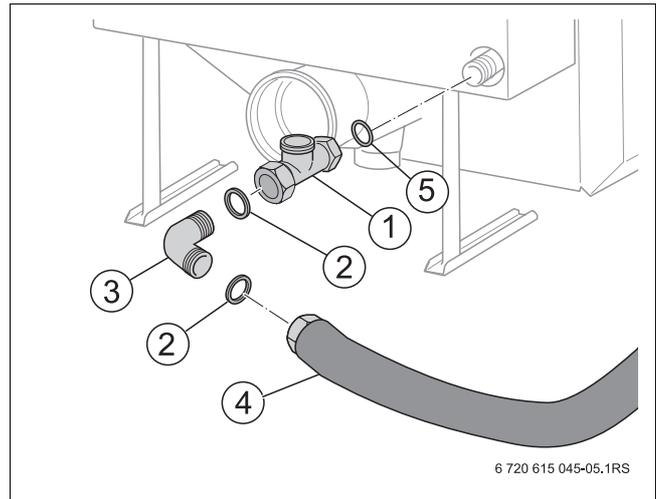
Rücklaufanschluss am Wärmetauscher montieren bei links nebenstehendem Warmwasserspeicher
